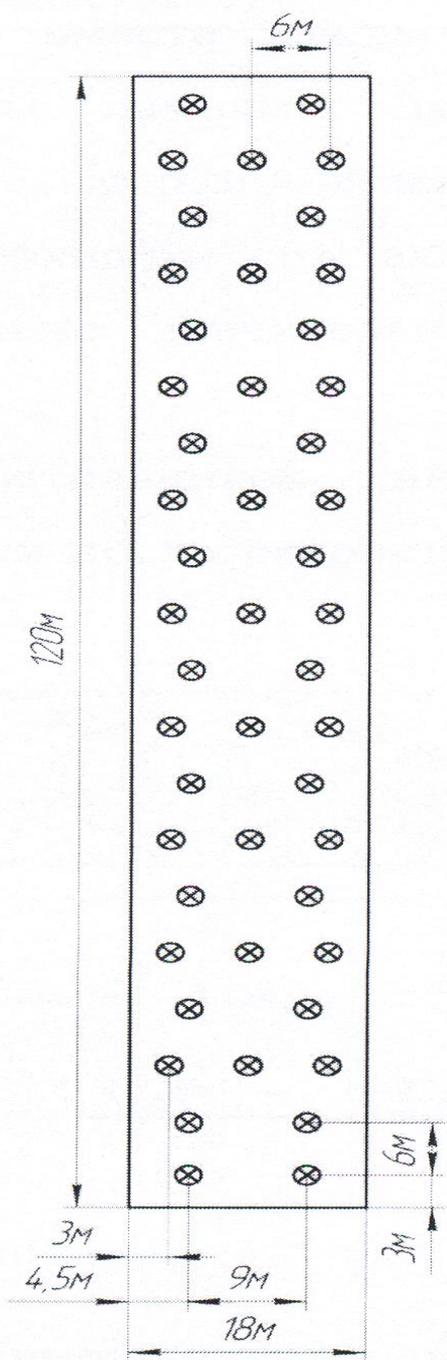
Схемотехнический расчет расположения светильников до реконструкции в помещении 2
